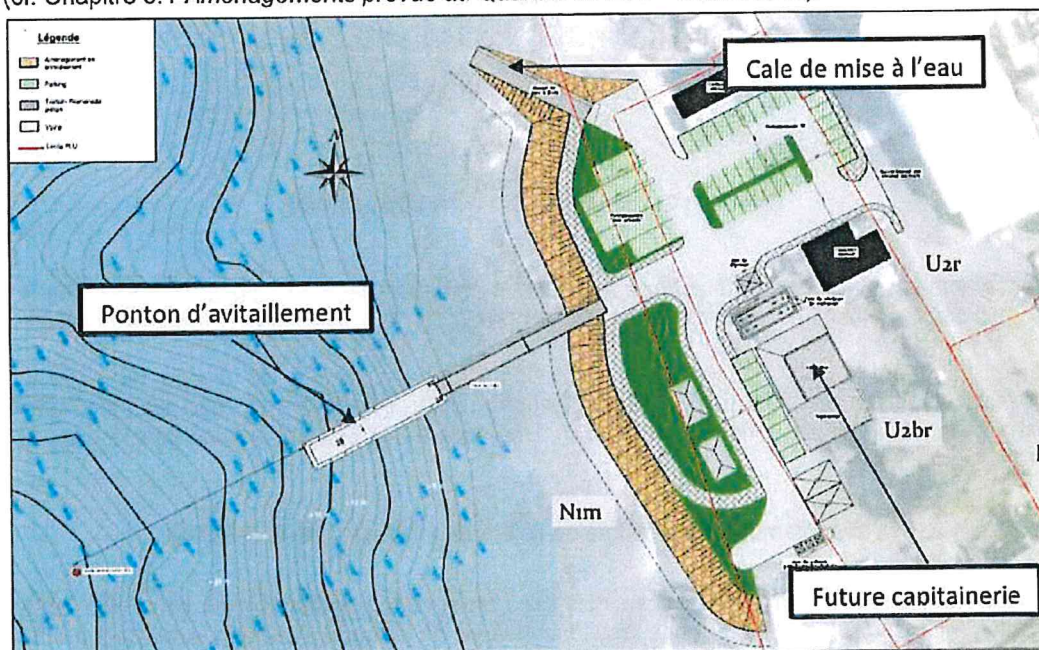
Plan de masse des installations à terre – Quartier du Fort – Saint-Pierre
